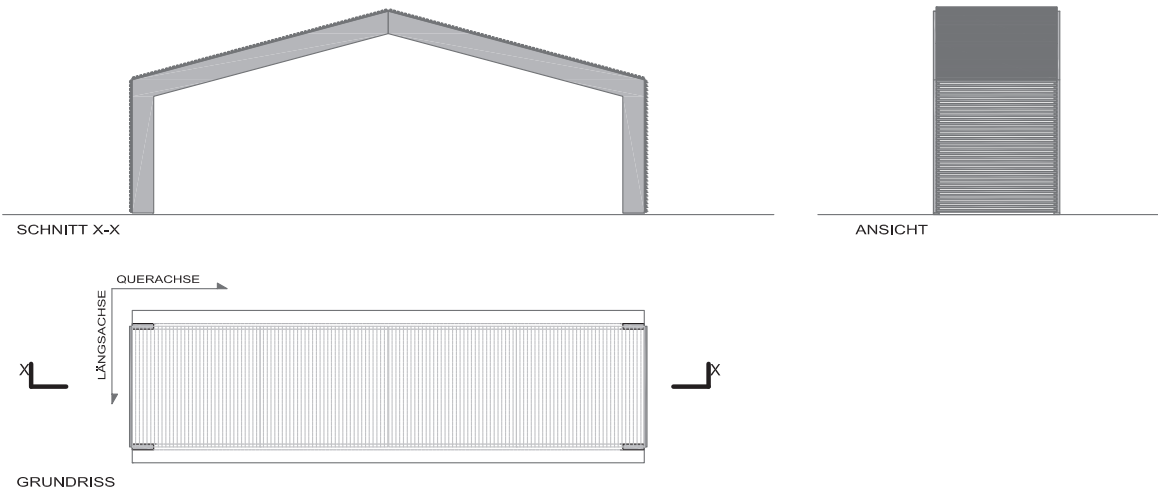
| Systemgrundriss mit Fassadenelement, Schnitt und Ansicht
